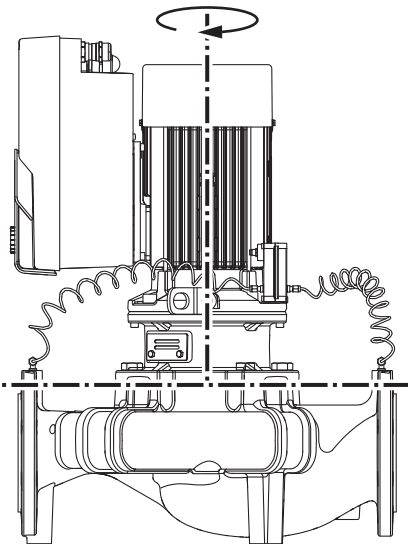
Zulässige Einbaulagen mit vertikaler Motorwelle
